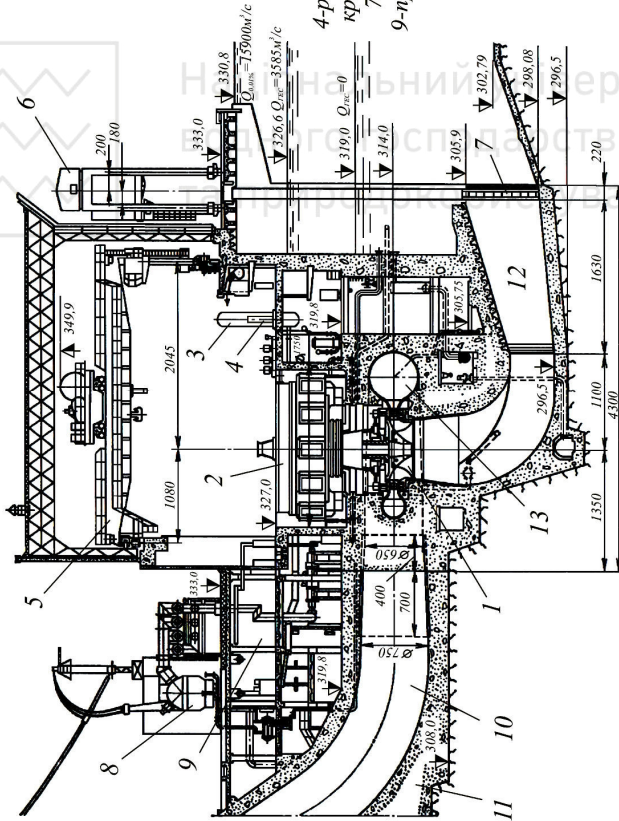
Поперечний переріз будівлі пригребельної ГЕС:
